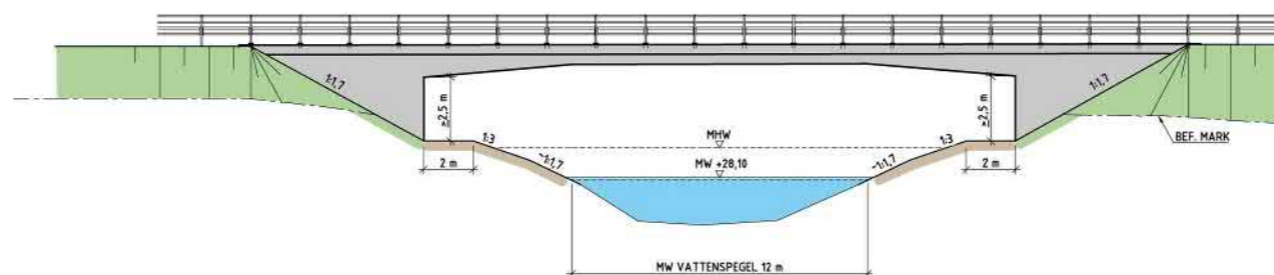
Bro över Grundträskån, elevation.
